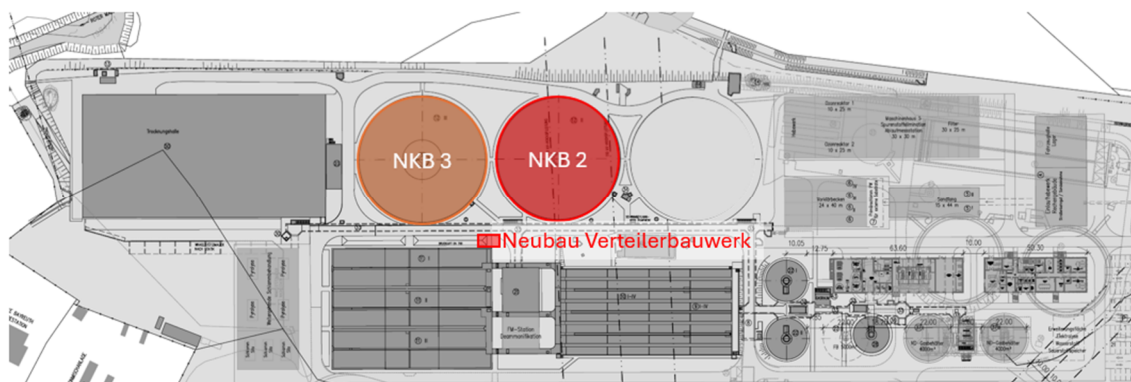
Lageplan mit Anordnung eines neuen Nachklärbeckens + Verteilerbauwerk
